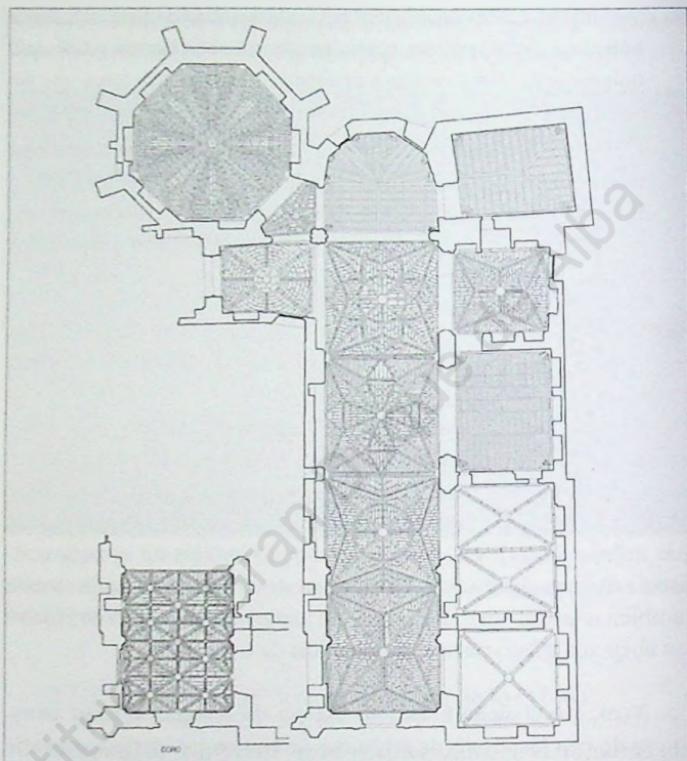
Planta de las bóvedas de la nave central y capillas (José Ramón Duralde).
